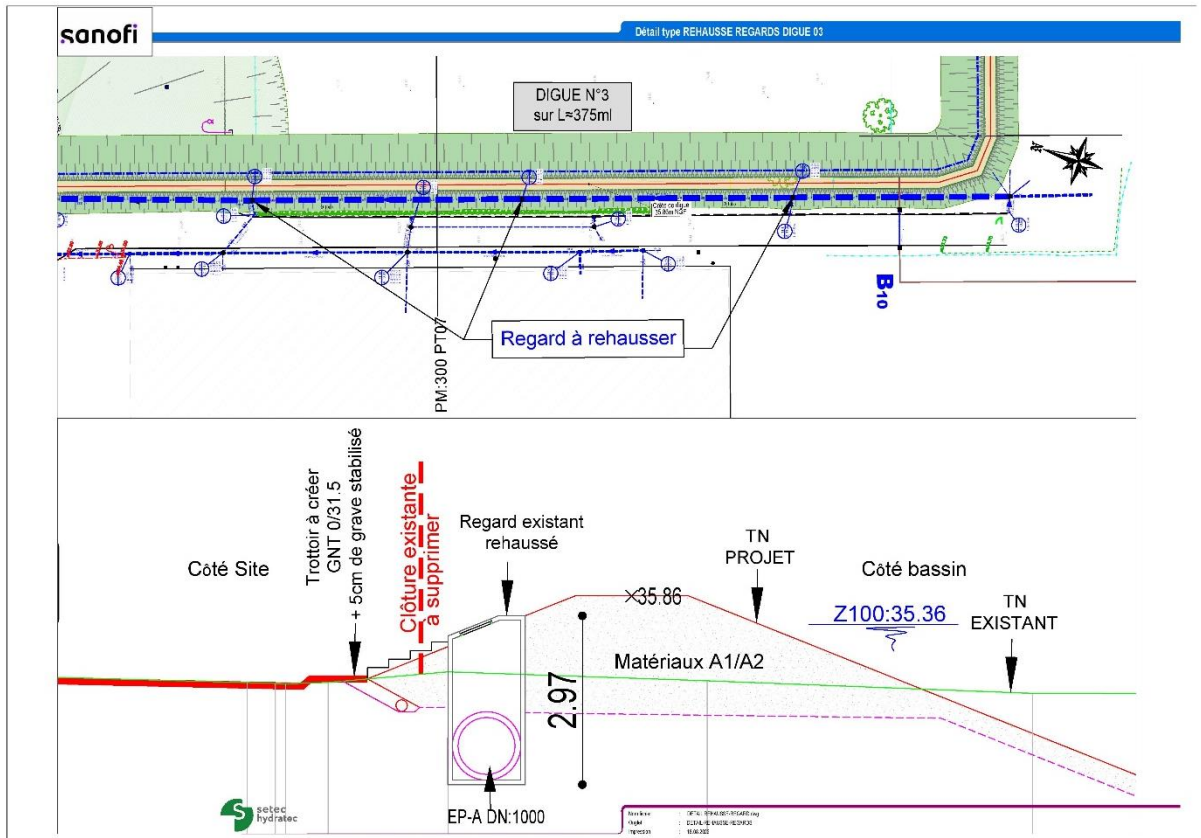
Rehaussement des tampons de la conduite 1000 mm en pied de la digue 3
